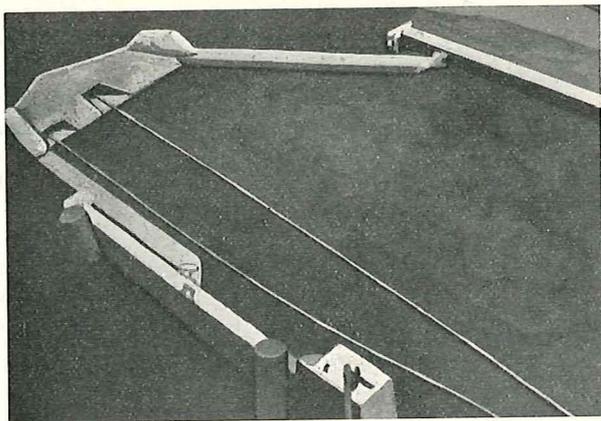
Châssis porte-poulie déplacé du côté gauche de la galerie.
